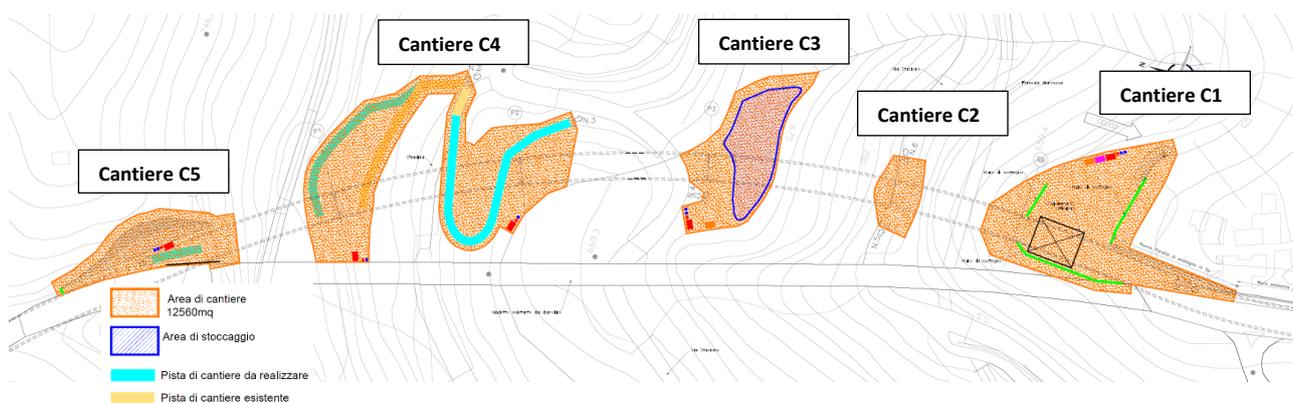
Estratto elaborato V382033000APA "Planimetria aree di cantiere e viabilità di servizio"
